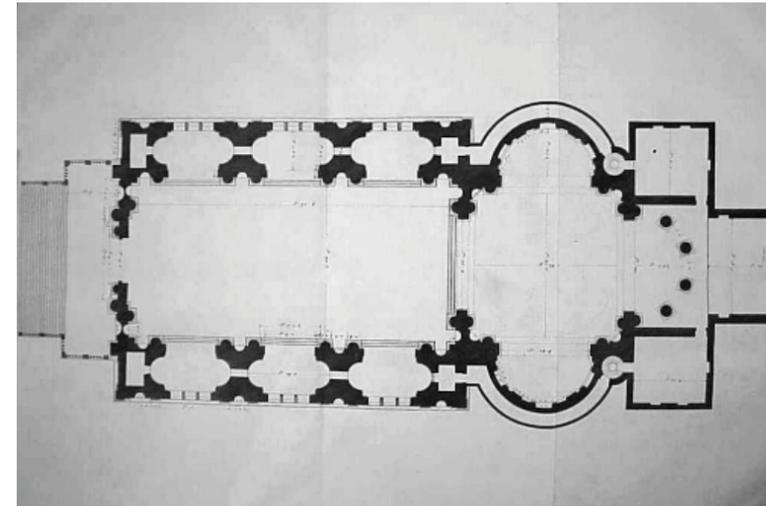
Grundriss, II Redentore, Venedig
